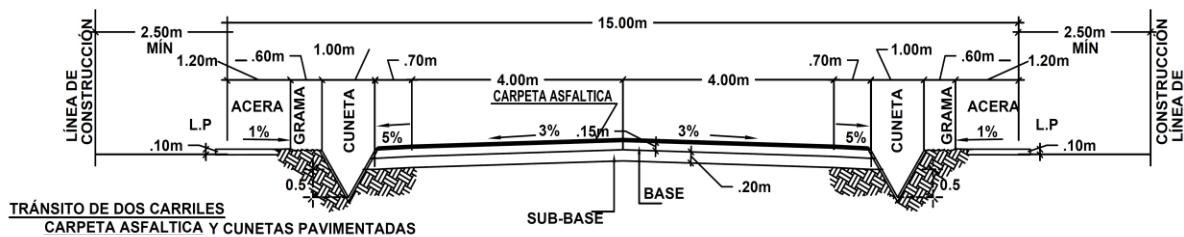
Sección típica de calle de 15.00m. Fuente: Plano de anteproyecto.
